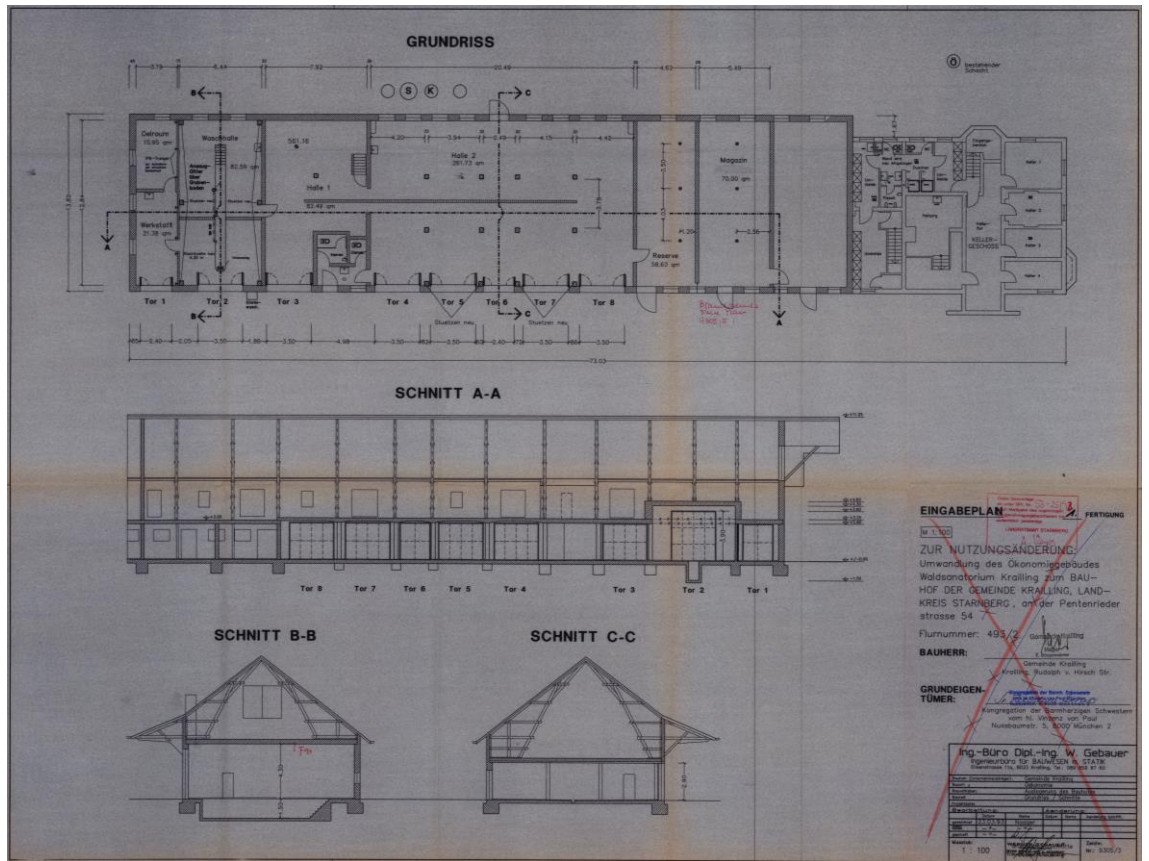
Grundriss und Schnitte zu den Um- und Ausbaumaßnahmen, (Genehmigungsbescheid 24.08.1993)
